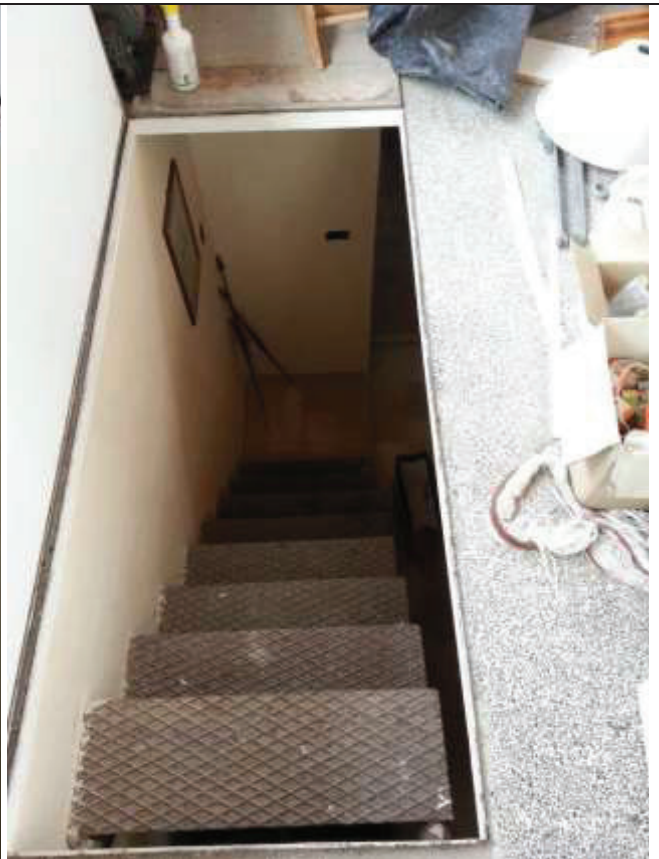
Scala metallica di accesso alla torretta in copertura.
